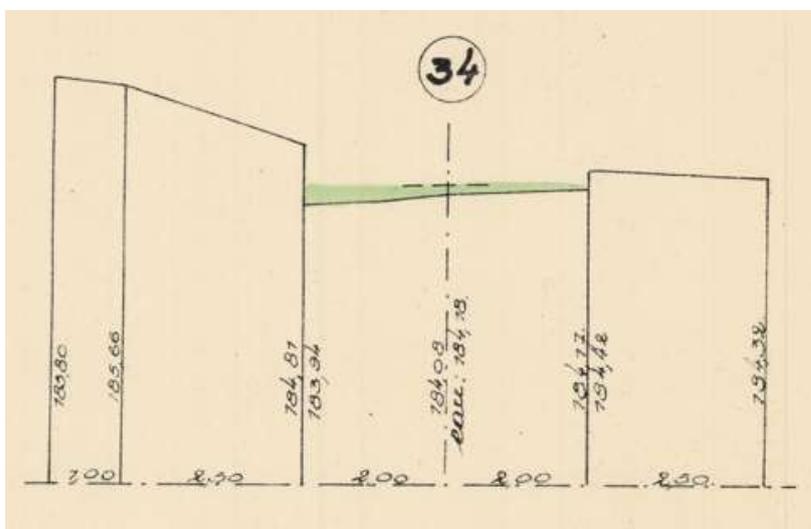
Exemple de profil en travers n°34 au niveau de Jassogne sur le Crupet.
